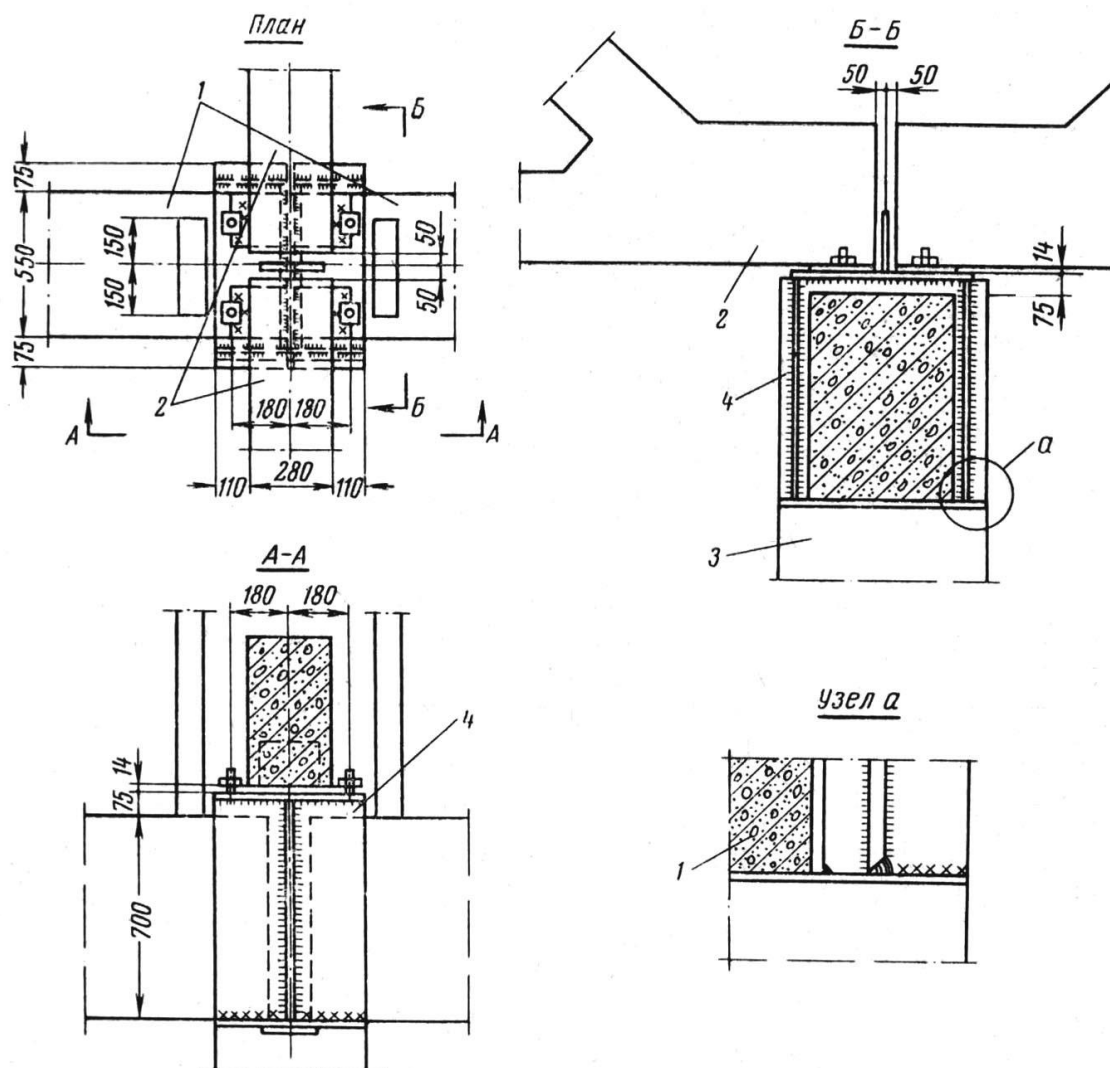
Устройство металлического башмака в узле стирания ферм покрытия на подстропильные балки и колонну:
